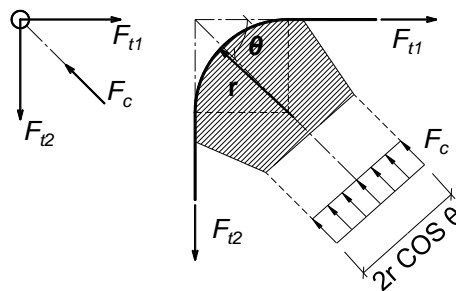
Druck-Zug Knoten mit Bewehrungsumlenkung der Längsbewehrung im Knoten 1 nach dem CEB Model Code [3]
